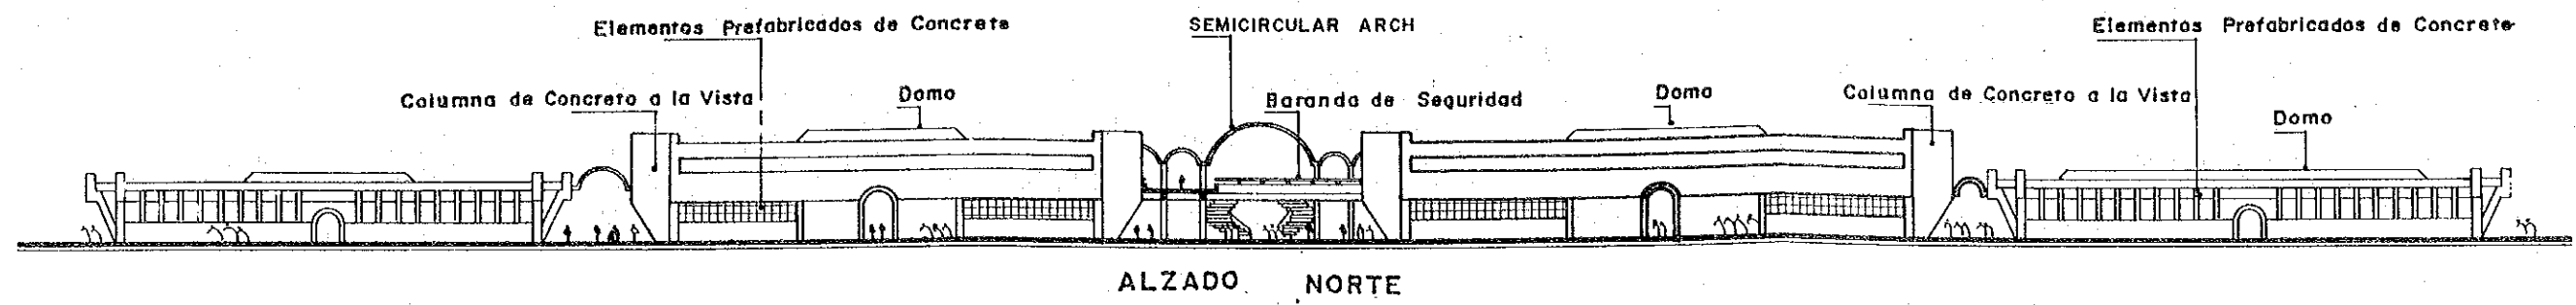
FACHADAS DEL MERCADO PUBLICO Y ESPECIFICACIONES DE CONSTRUCCION
